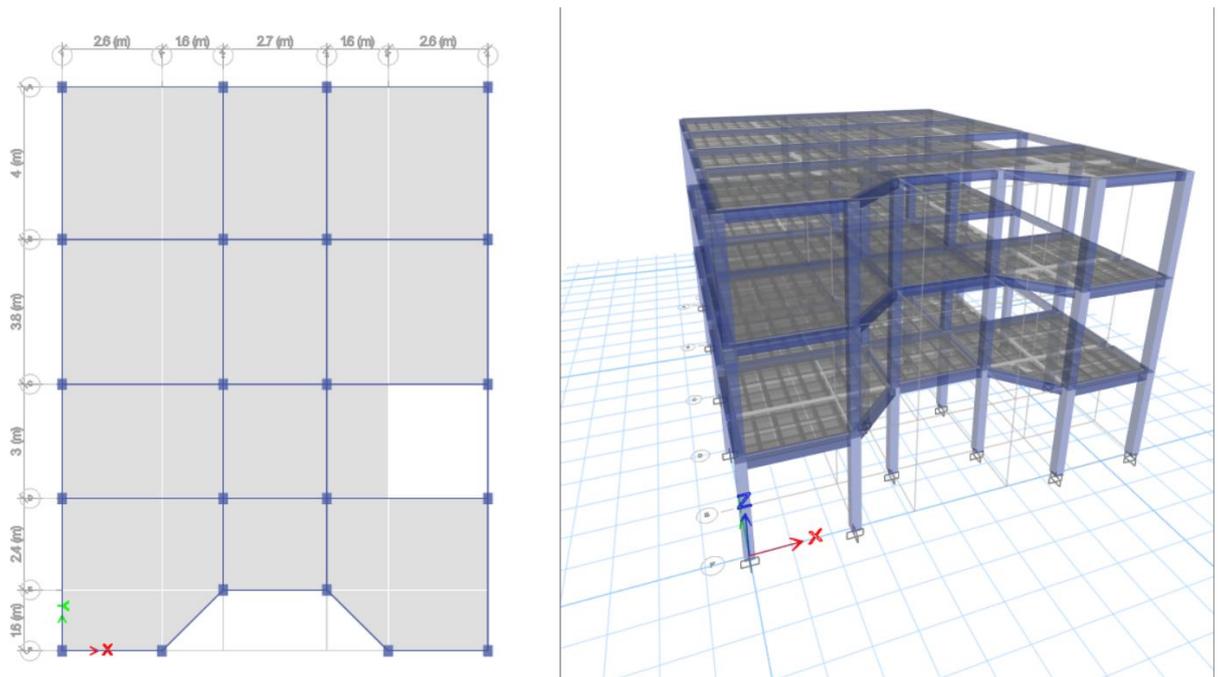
Modelado de la estructura en el programa de análisis estructural, vista en planta y en 3D extruida.
